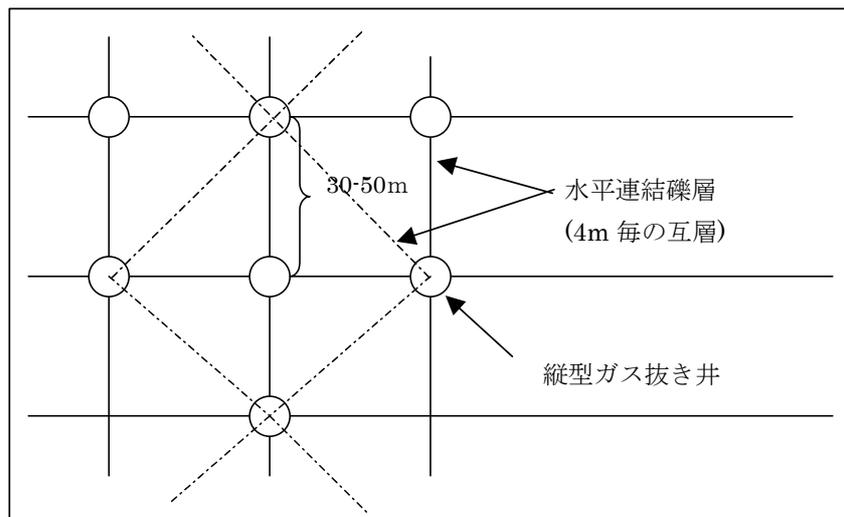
毛萱子埋立場のガス抜き井の平面配置図
